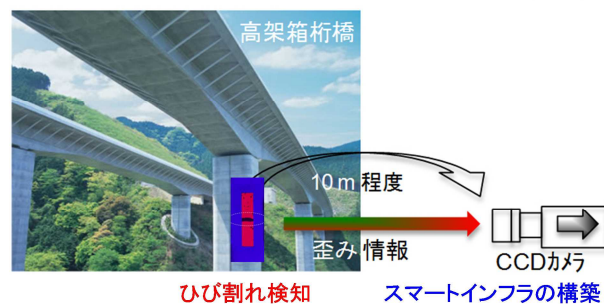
ひび割れ検出によるスマートインフラの構築
